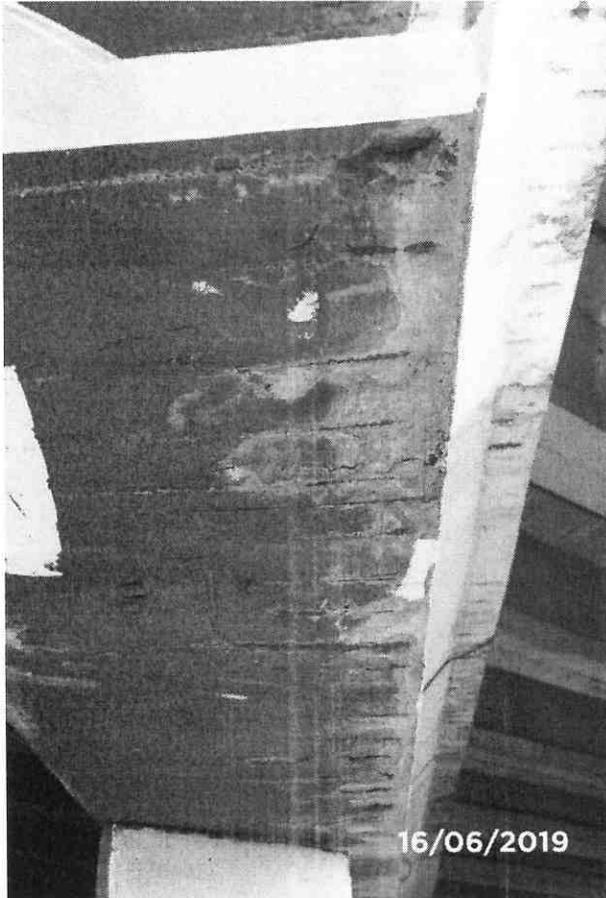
Armadura exposta na viga de travamento transversal sobre os pilares centrais.
